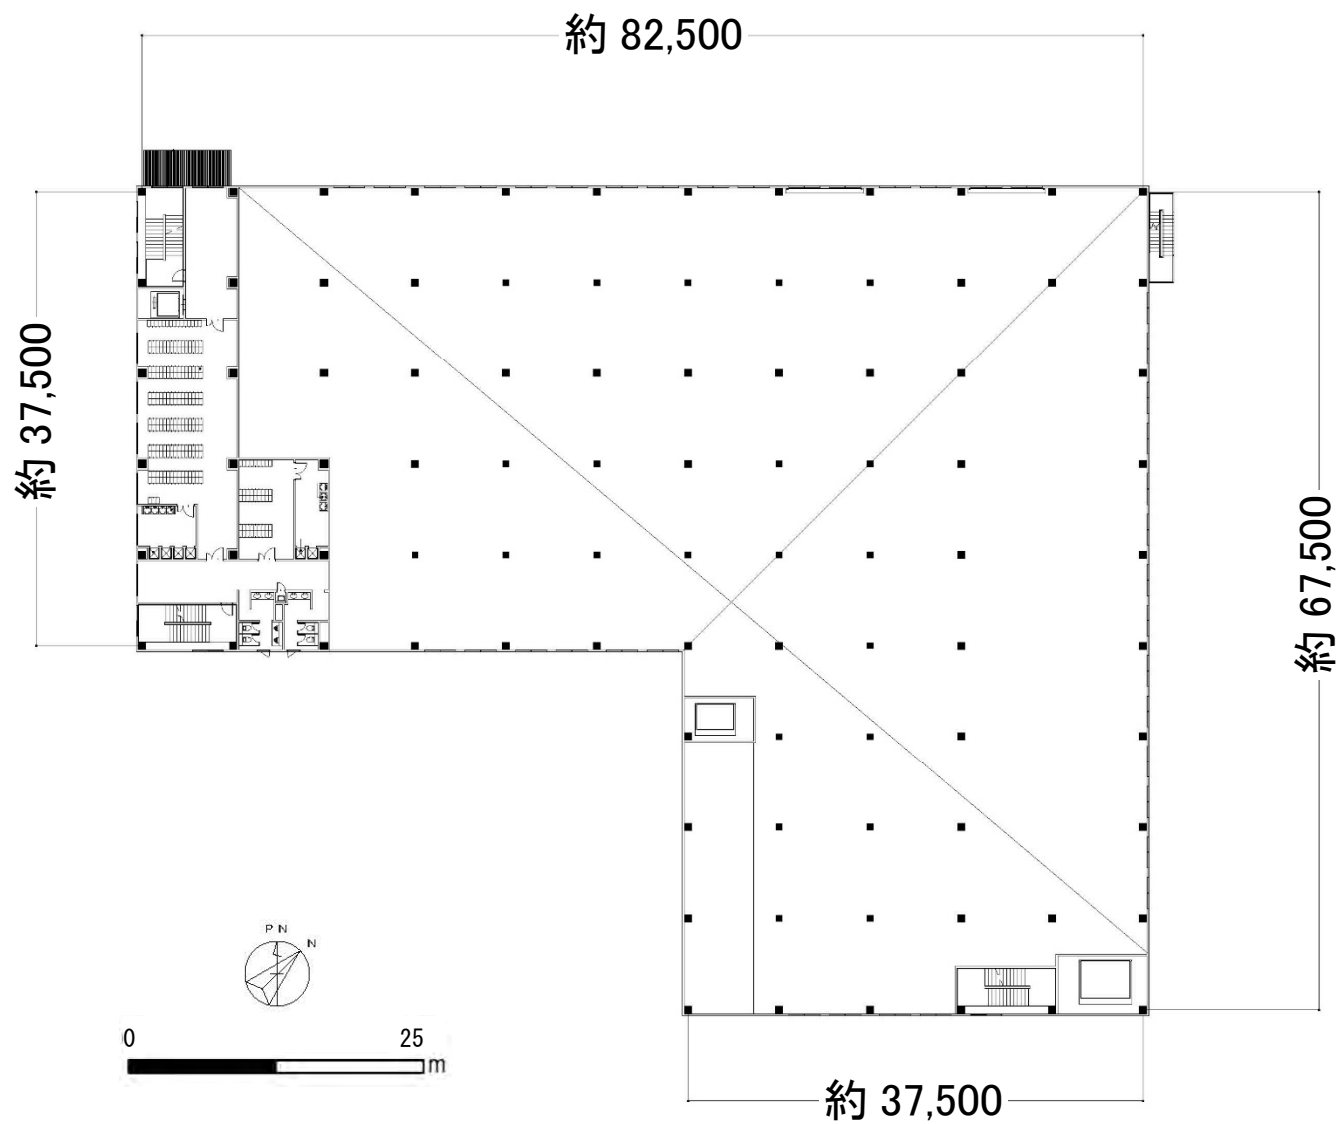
(2) 計画建物平面図 (2 階) : 単位 mm
